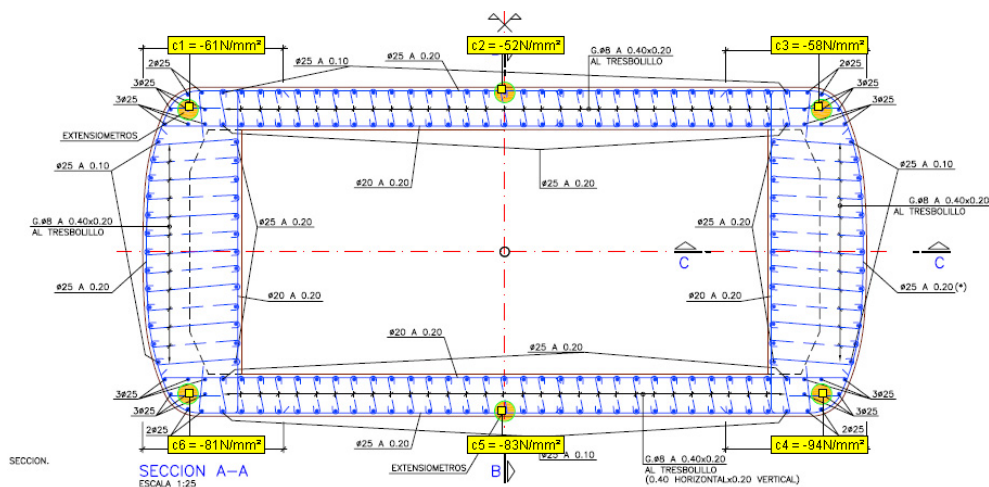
Instrumentación con extensómetros de barra de una de las secciones de arranque del arco.
